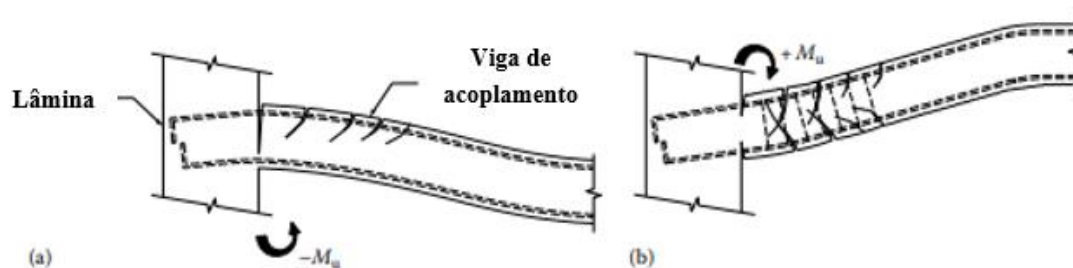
Fissuração das vigas de acoplamento devido a uma ação cíclica adaptado de [1]
